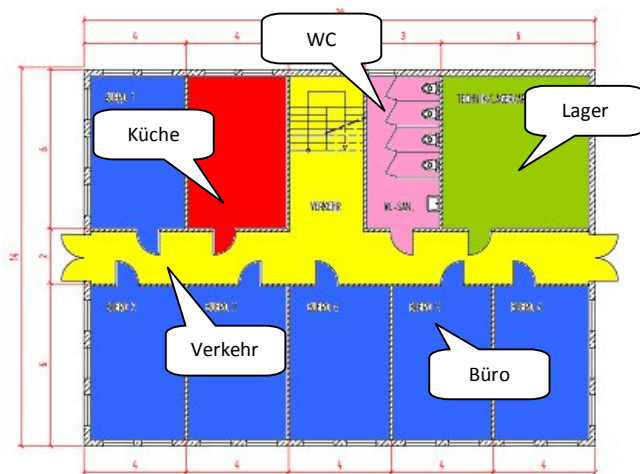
Grundriss Regelgeschoss mit Zonierung, Geb.1
